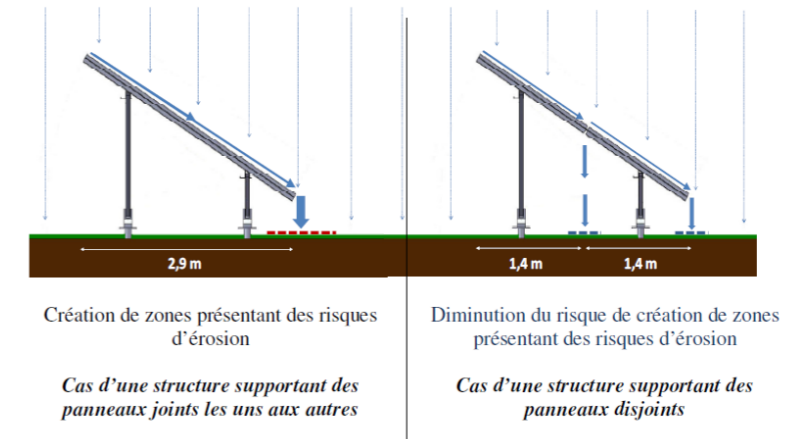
Structures porteuses supportant des panneaux joints ou disjoints
